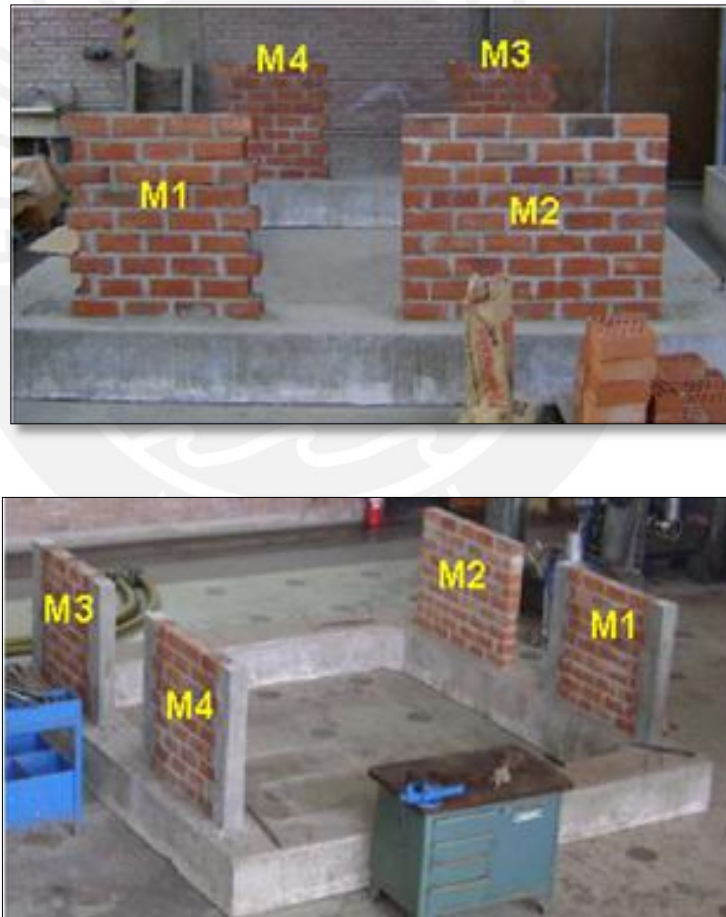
Parapetos analizados. Primero se construyó la albañilería sobre un anillo de concreto, después se construyeron las columnetas.
